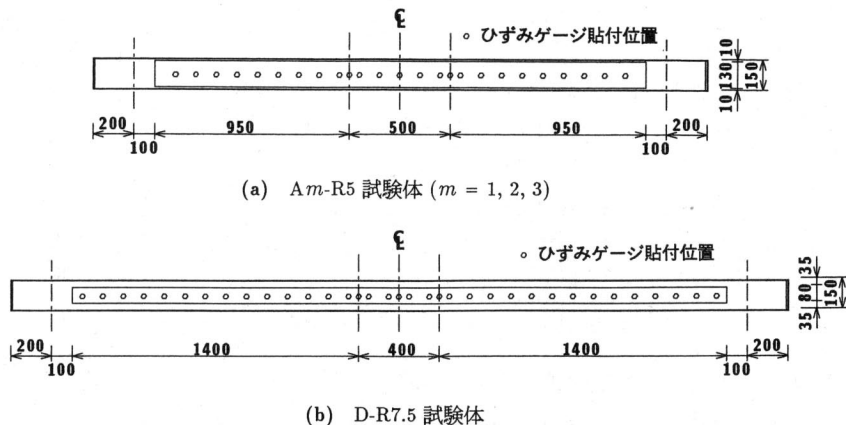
AFRP シートの接着状況の概要とひずみゲージ貼付位置 (mm)
